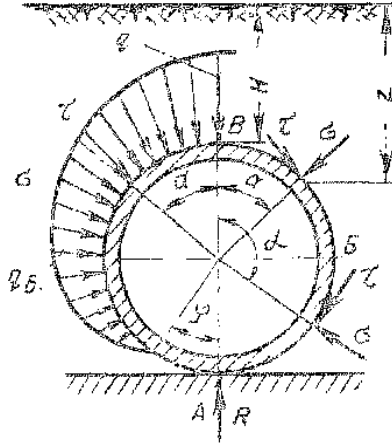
Расчетная схема определения нормальных и касательных напряжений подземных трубопроводов
